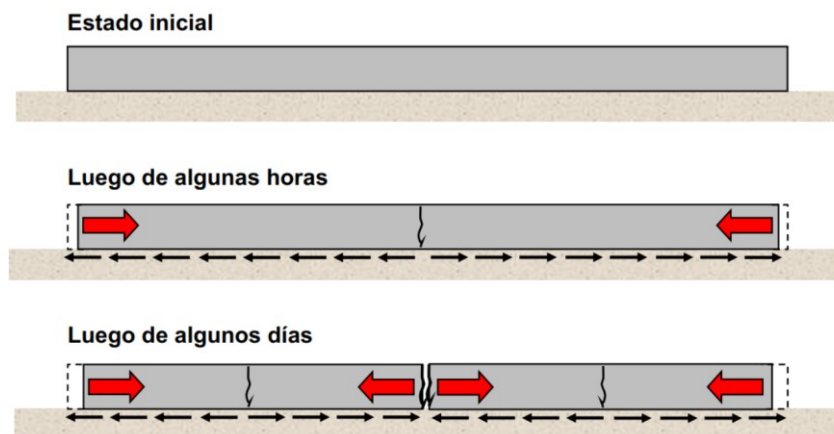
Contracción por secado en losas y formación de fisuras por restricción de la superficie.
